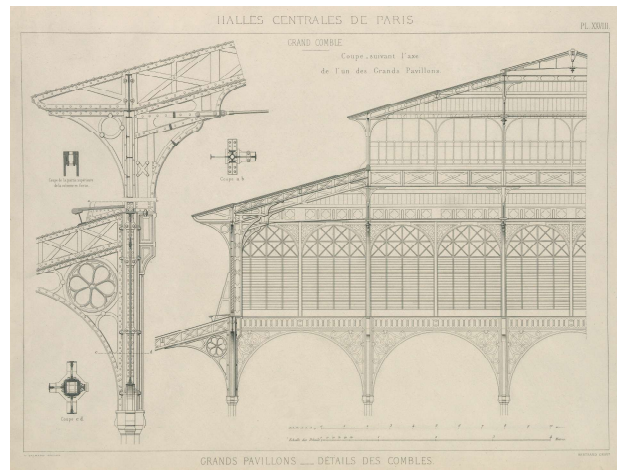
Detalhe construtivo do sistema de cobertura do pavilhões das *Halles Centrales de Paris*.
